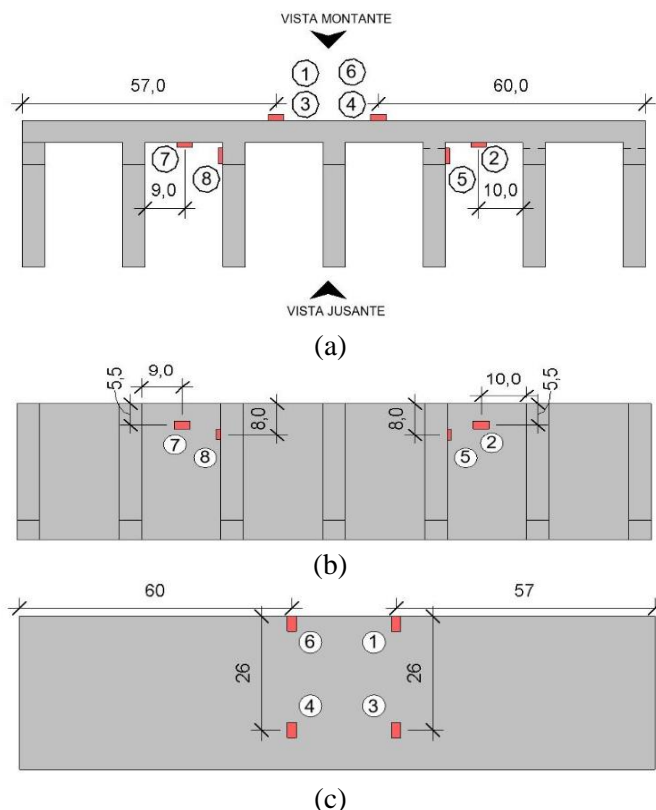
Esquema do posicionamento dos extensômetros no modelo: Planta baixa (a); Vista jusante (b); Vista montante (c)
